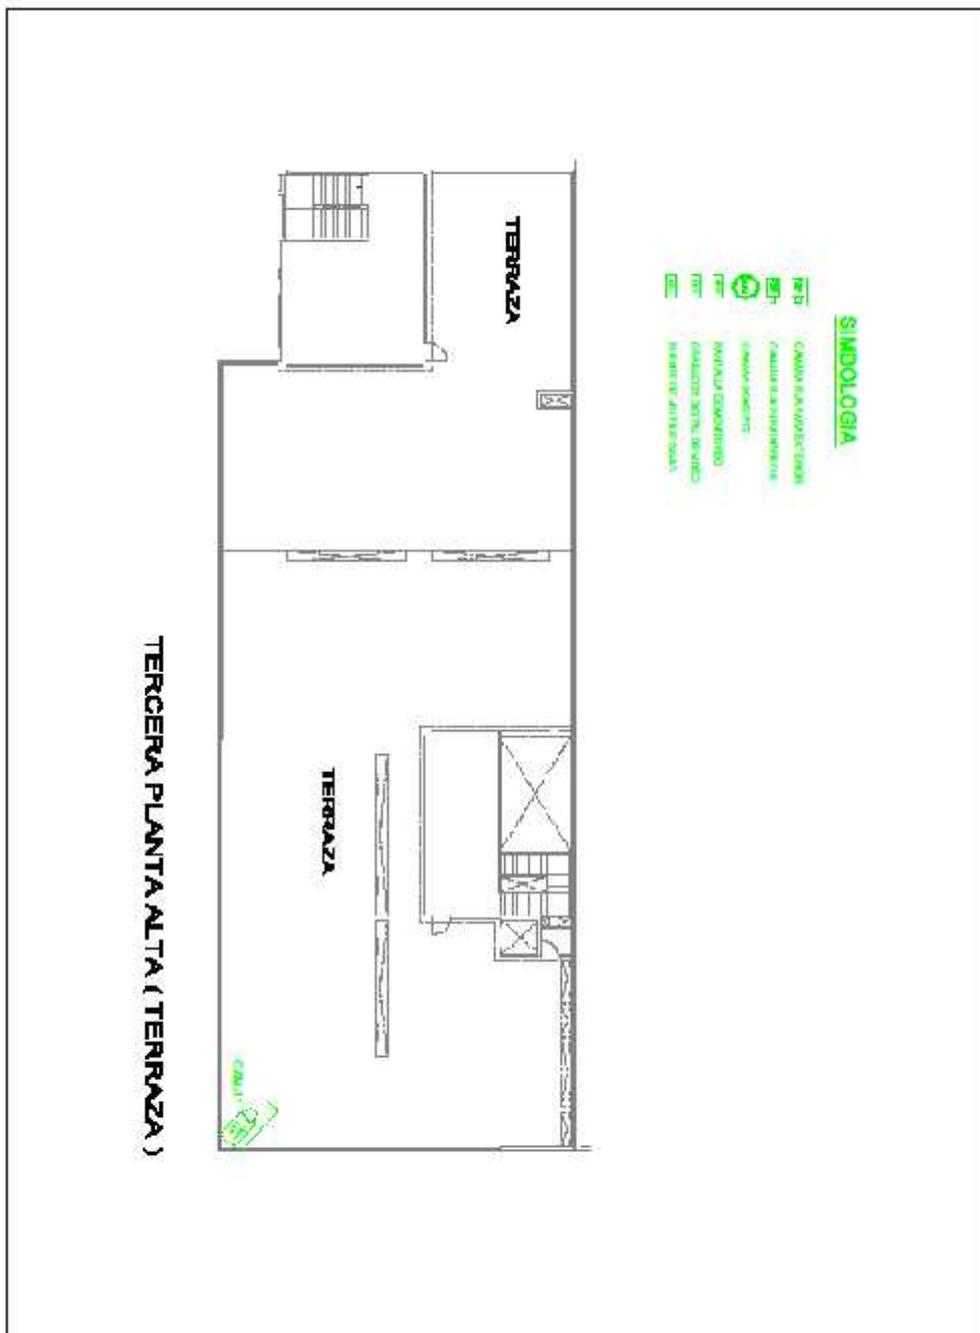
Cámaras CCTV en la salida a terraza planta salida a terraza
